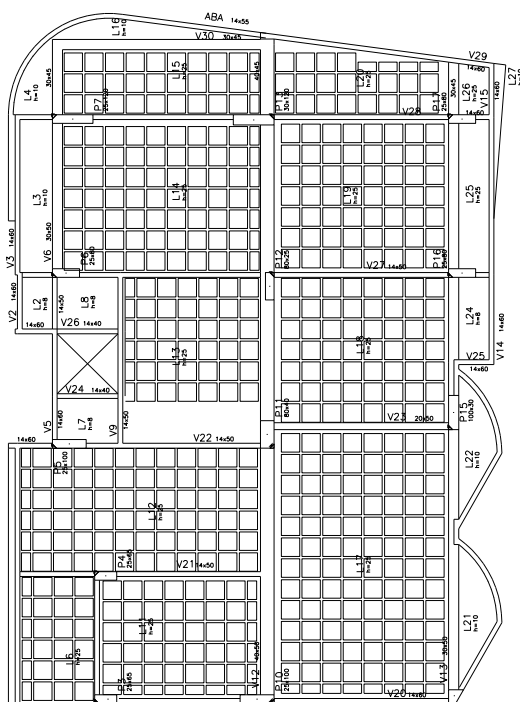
Edifício Mustique – Vigas + Lajes nervuradas.
